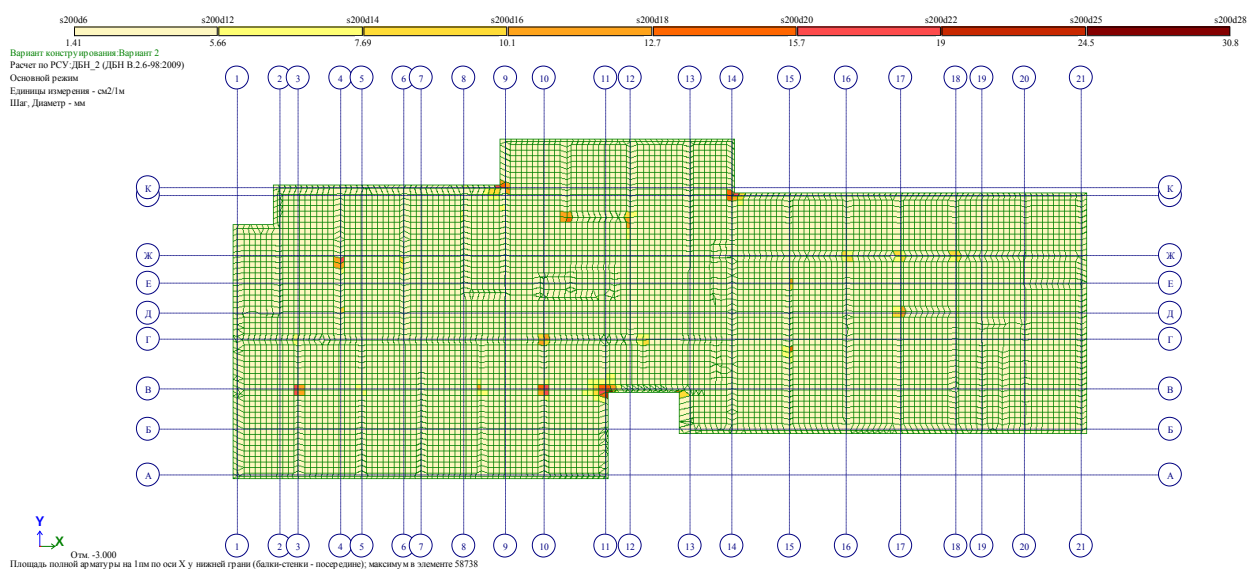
Площадь полной нижней арматуры на 1 м.п. по оси X
